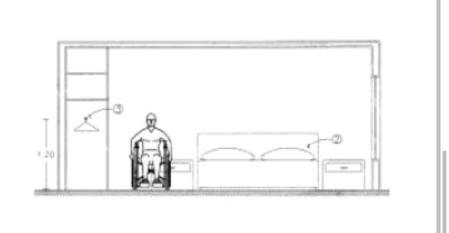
Planta y alzado de ejemplo de mingitorios para discapacitados. IMAGEN 11 Planta y alzado de ejemplo de habitaciones para discapacitados.
